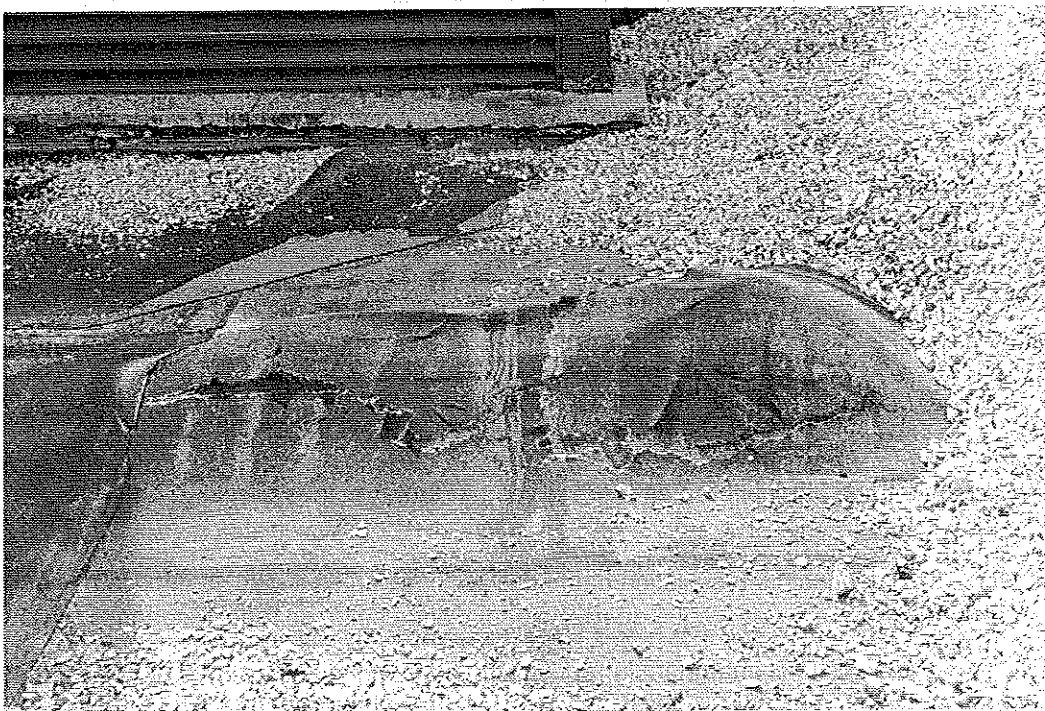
Détail de la cloque. Gonflement et rupture du revêtement d'étanchéité. © J. Putatti
